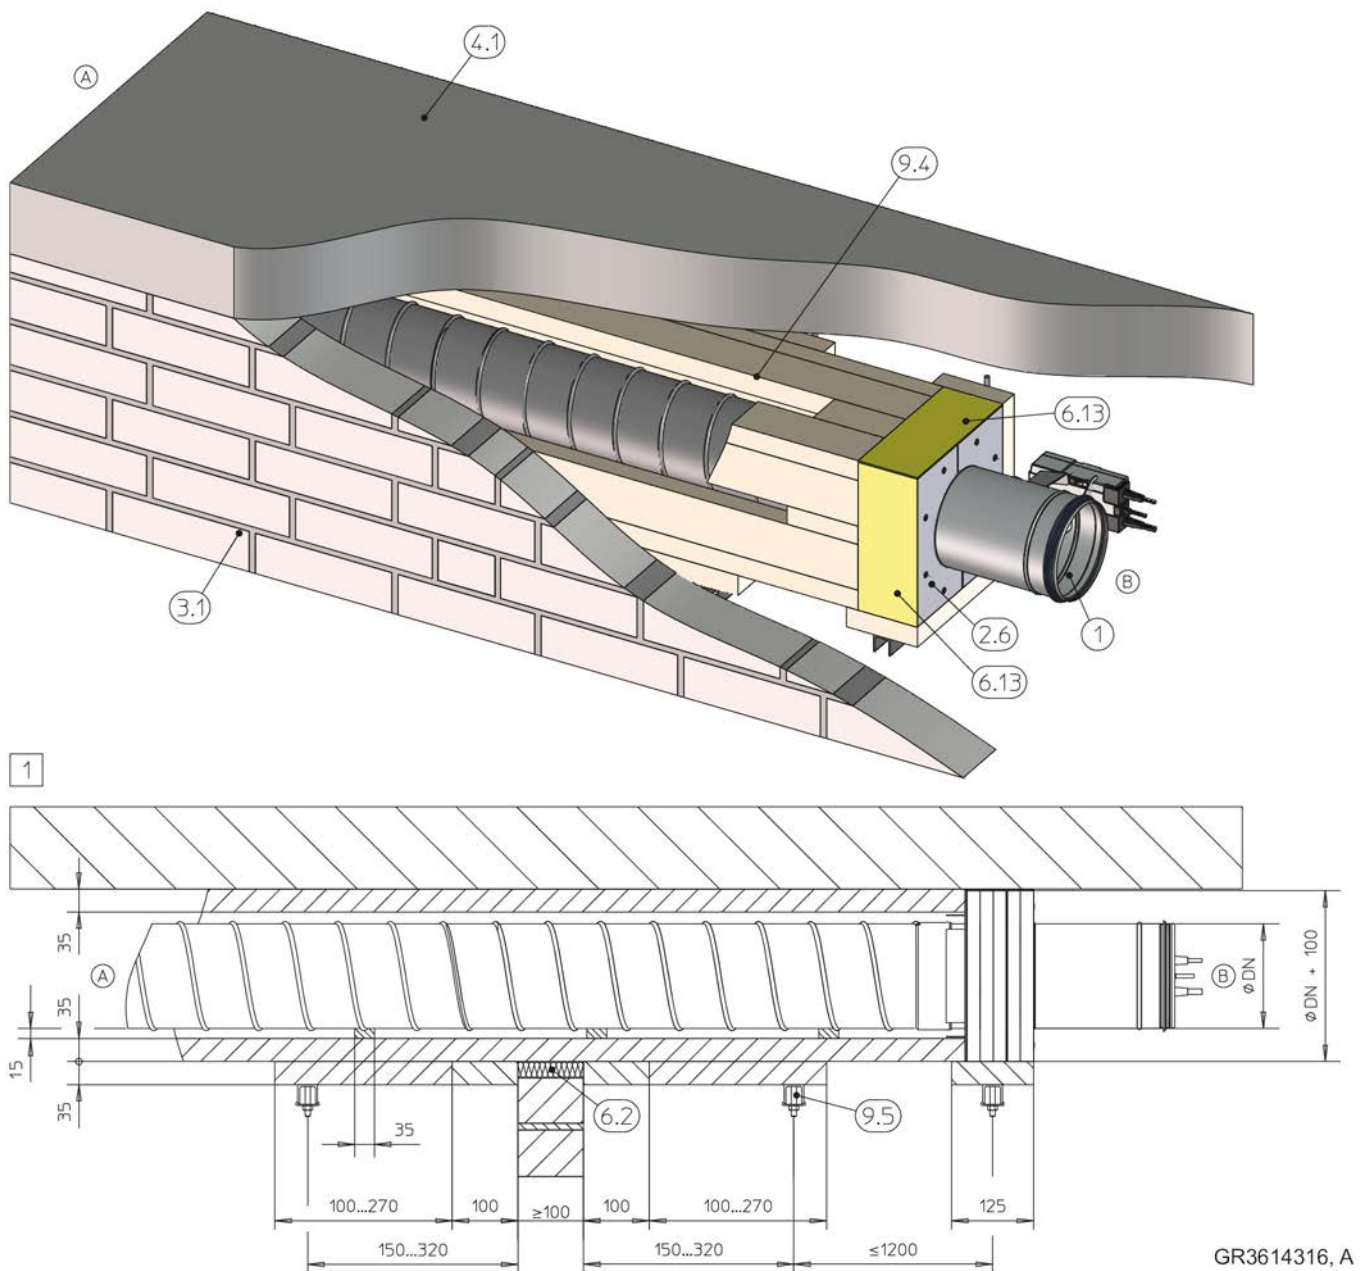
Монтаж без раствора на удалении от сплошной стены с проходом через стену, с облицовкой с двух сторон
